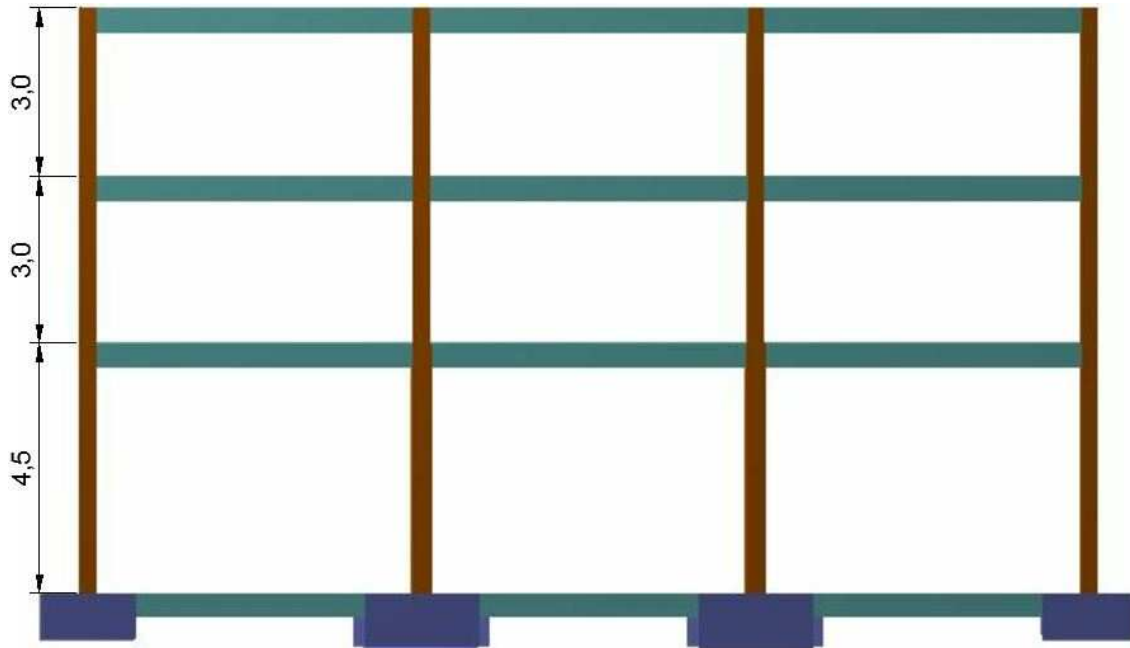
Vista en perfil. Edificio de 3 plantas.
